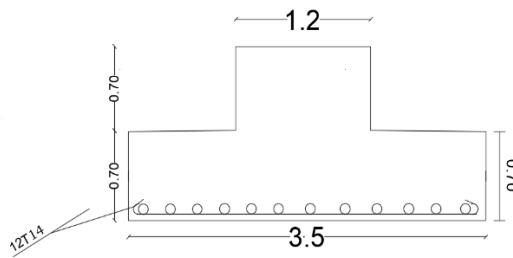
ferrailage de la semelle sous poteau selon le sens x-x
